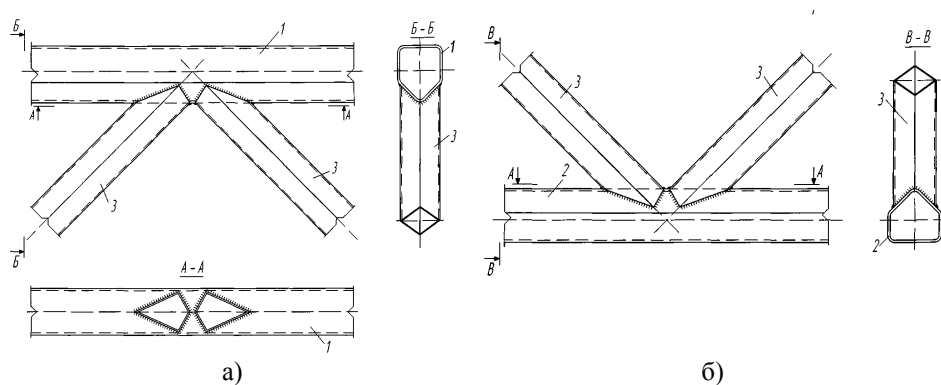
Схемы узлов трубчатых элементов верхнего (а) и нижнего (б) поясов фермы
